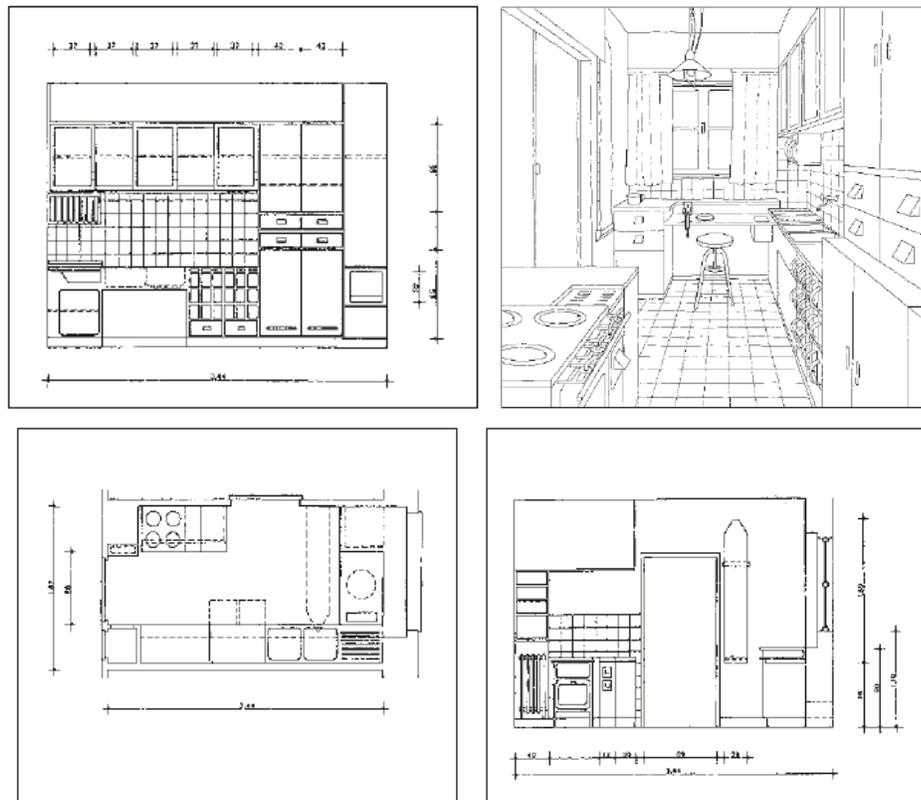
Grete schütte-lihotzky: Cocina de Frankfurt, 1927. Vista general y planimetría.
